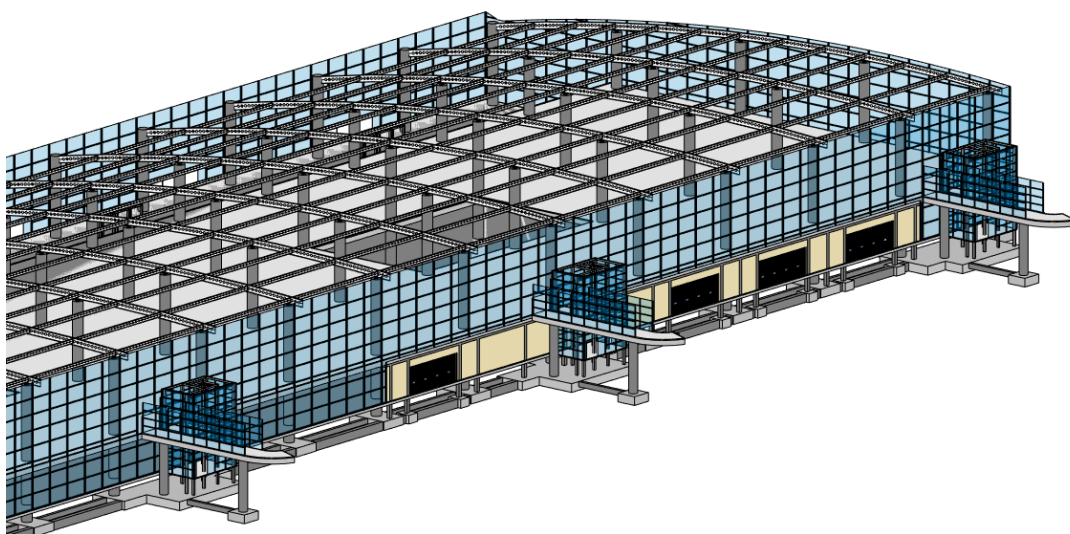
Cerramiento y puertas automáticas en la zona de tratamiento de equipajes.
